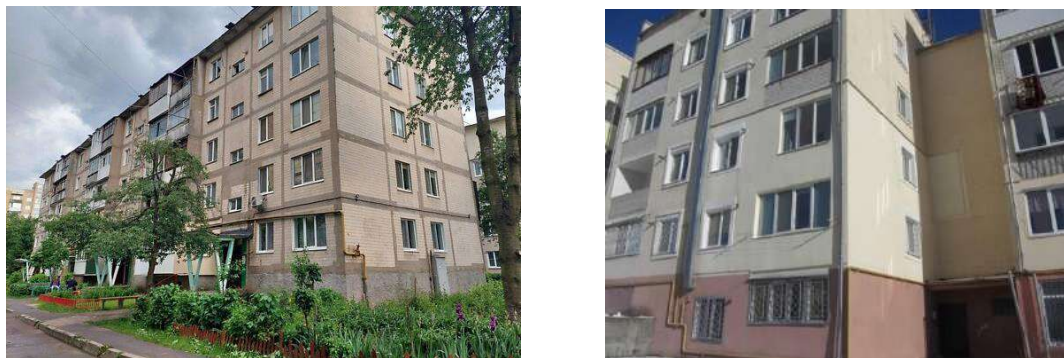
Житловий будинок типового типу та утеплення фасадів
